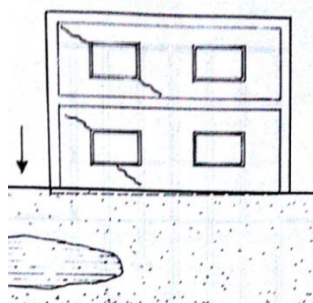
Fissuração devido à interferência nos bulbos de construções vizinhas
